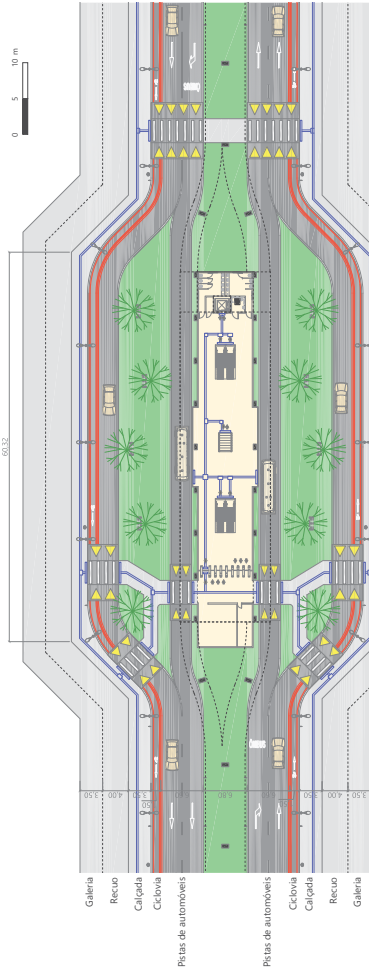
Planta Térreo da Estação (Autor, 2018)
